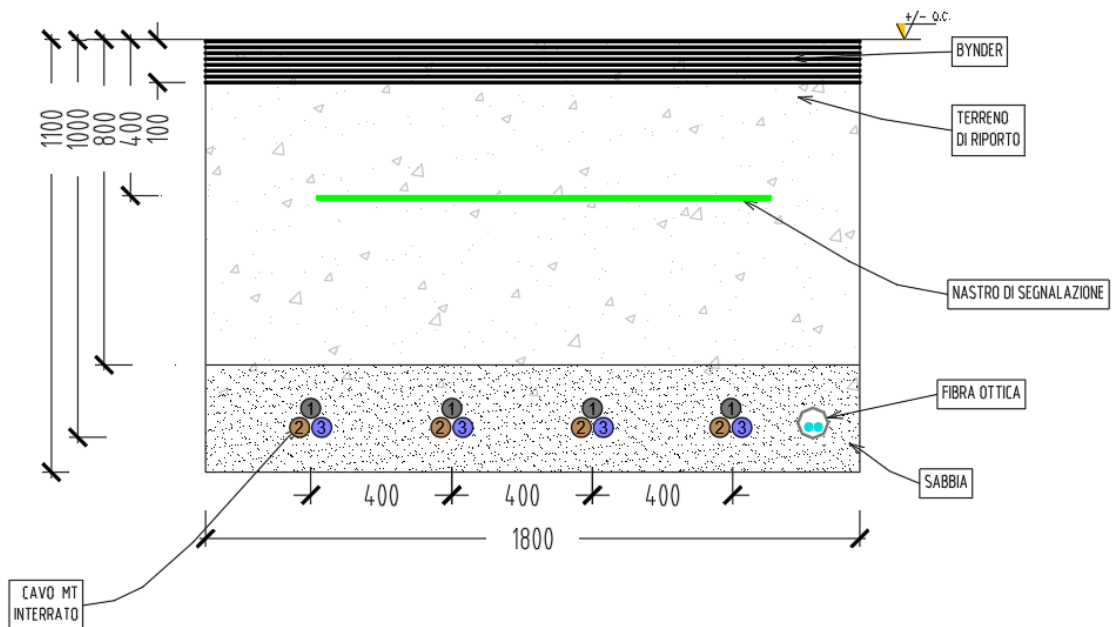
Tipico sezione di scavo MT su sede stradale
